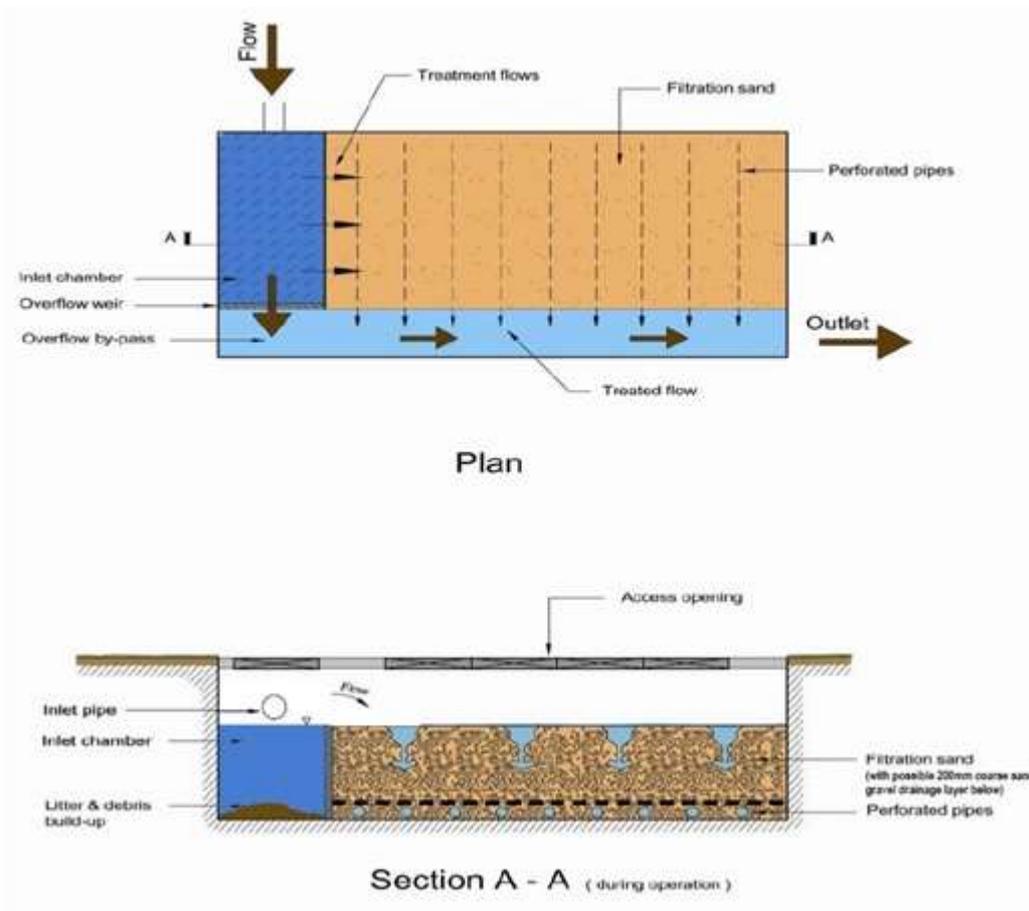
Planta e corte longitudinal de um filtro de areia
